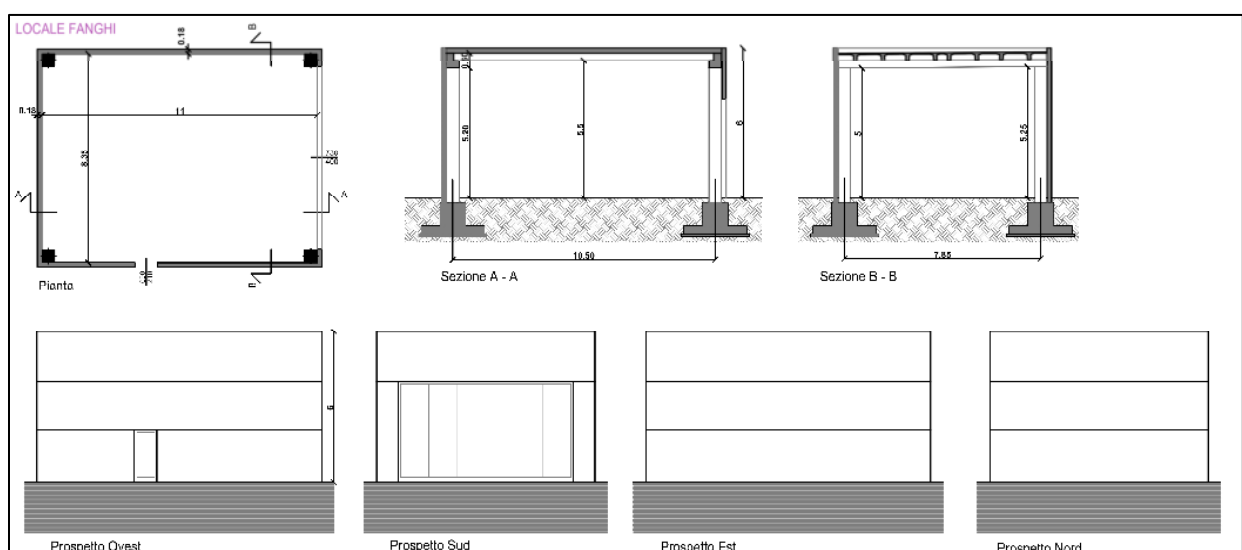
Pianta, prospetti e sezioni locale fanghi
